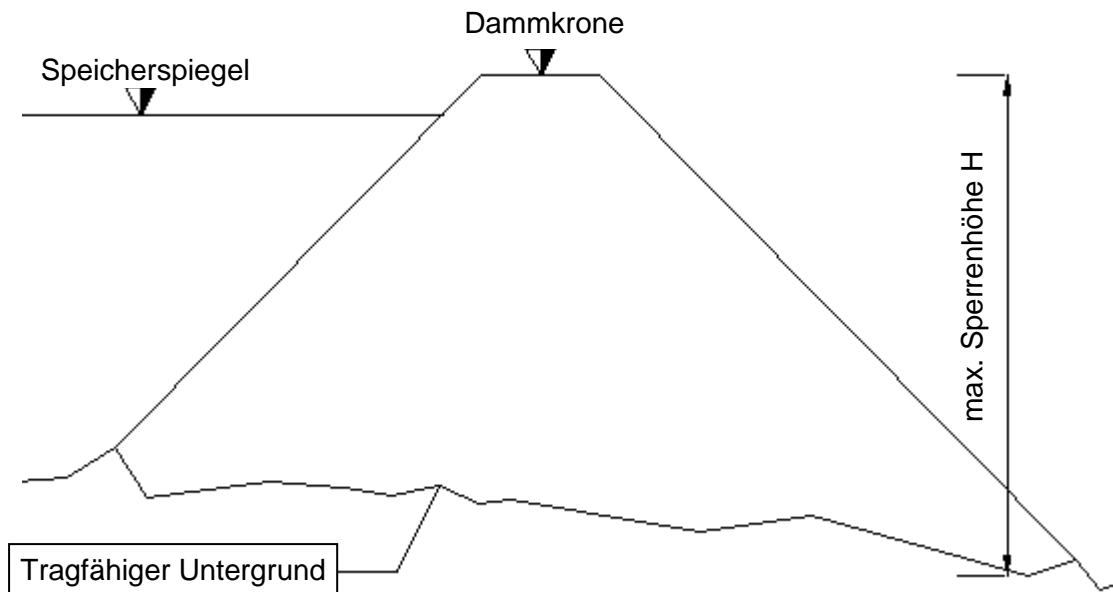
Systemskizze Speicheranlage [59: S. 9]
